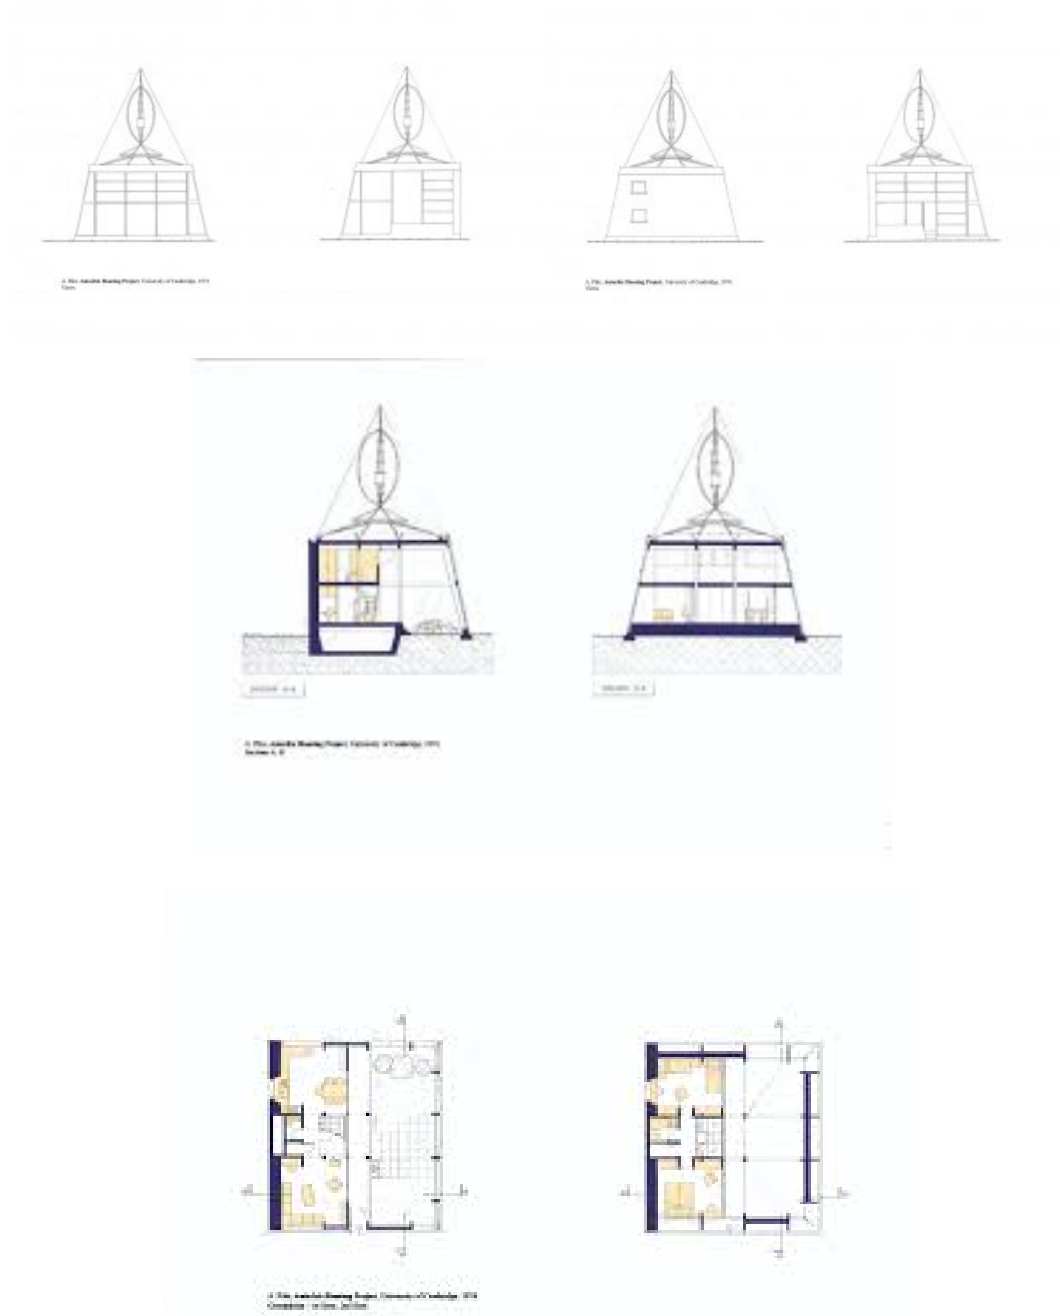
/ 8: Alzados, secciones y plantas de casa autosuficiente. Autor del proyecto Mr. Alexander Pike.
